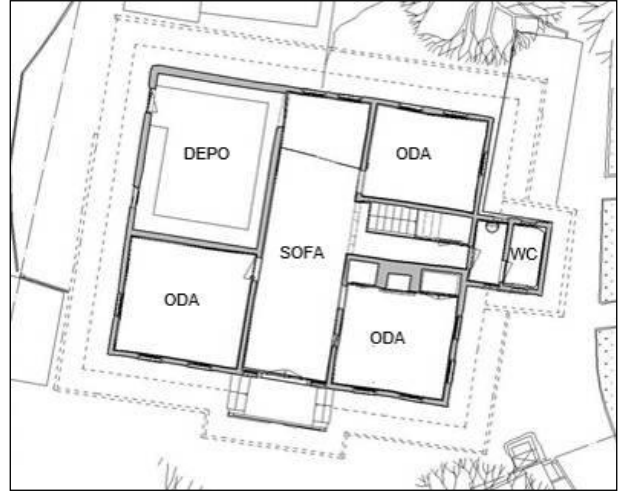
Vaziyet planı-rölöve ve yapı görünümü
